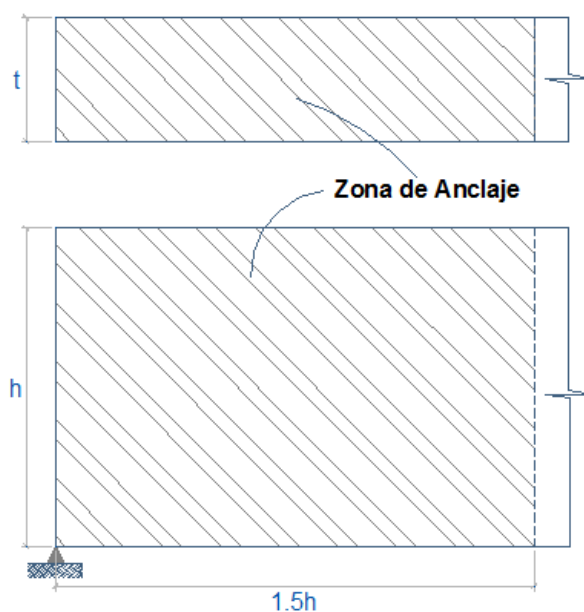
Zona de anclaje. Fuente: Elaboración Propia.
